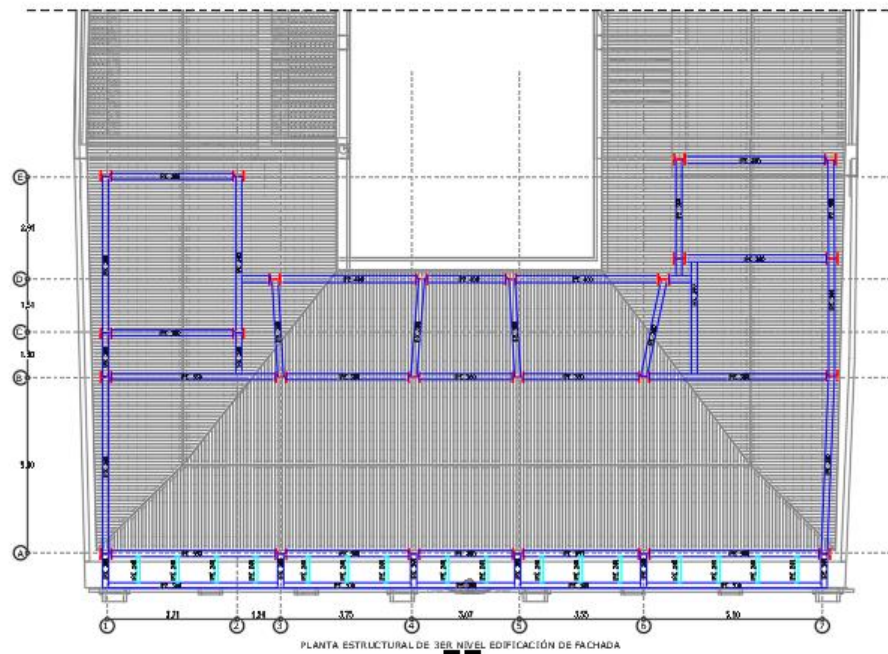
Planta de viga de cornacion en cubierta. Fuente. Ing. Alvaro Caballero
